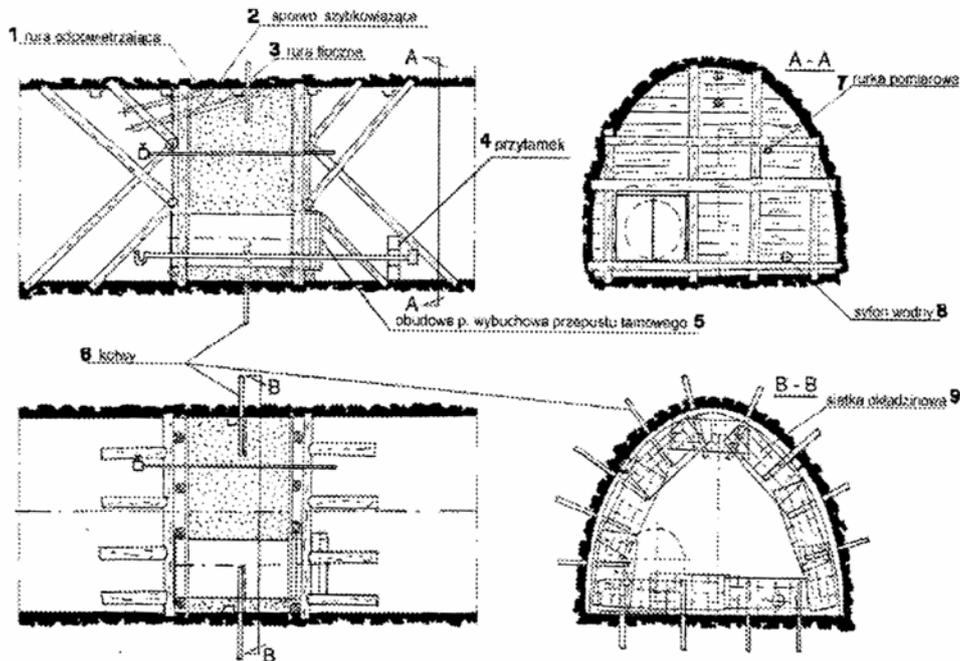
Взрывоустойчивая перемычка из быстрохватывающего вяжущего без вруба с армировочными элементами в виде анкеров и стальной облицовочной сетки: 1 – воздухоотводящая труба; 2 – быстрохватывающее вяжущее; 3 – нагнетательная труба; 4 – фильтрующий порог; 5 – взрывоустойчивая крепь пропуска перемычки; 6 – анкеры; 7 – измерительная трубка; 8 – сифонная водопускная трубка; 9 – облицовочная сетка
